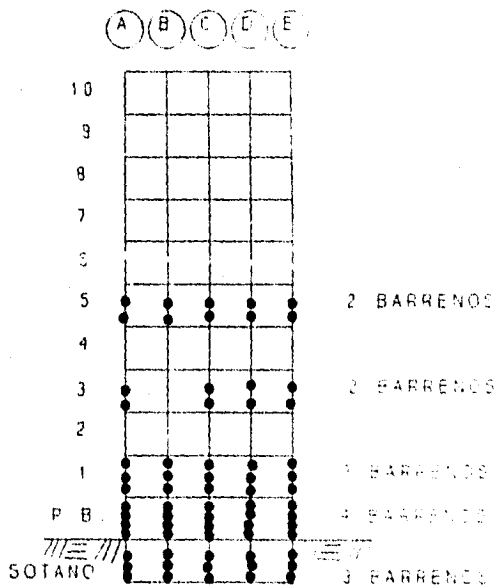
NUMERO DE NIVELES A PREPARAR Y CANTIDAD DE BARRENOS EN CADA COLUMNA.
